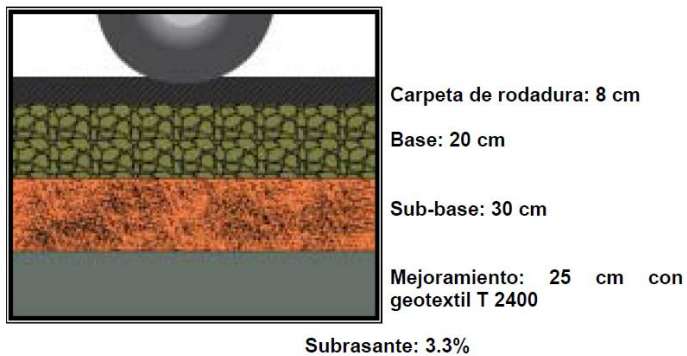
Estructura del pavimento para tramo 1 (III Etapa)
